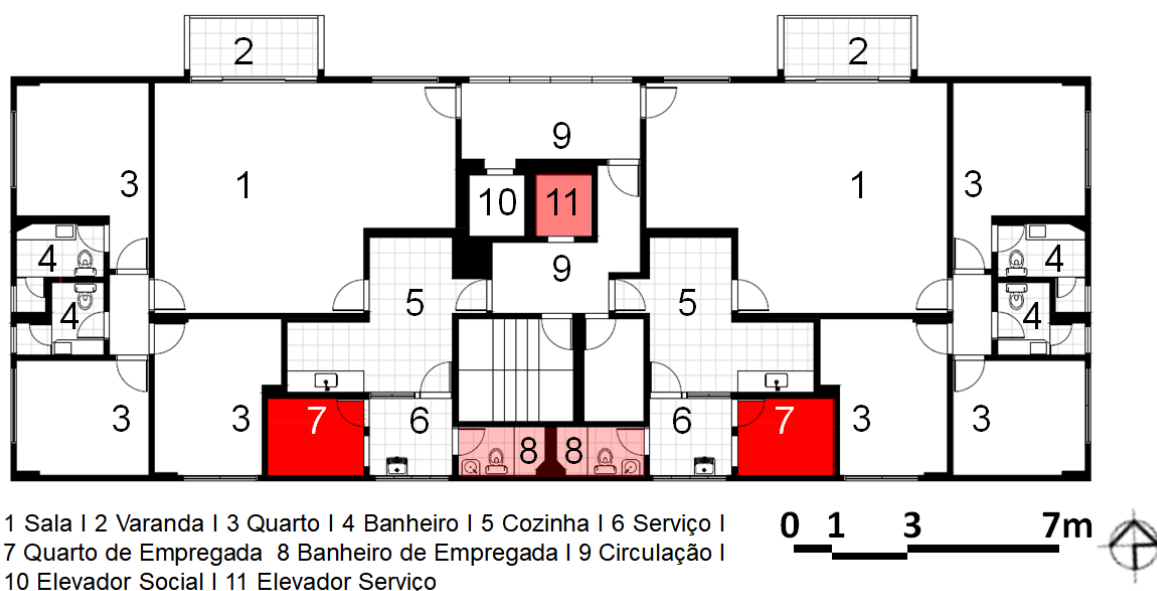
Planta-baixa do pavimento-tipo do edifício de apartamentos Estrela de Ouro
